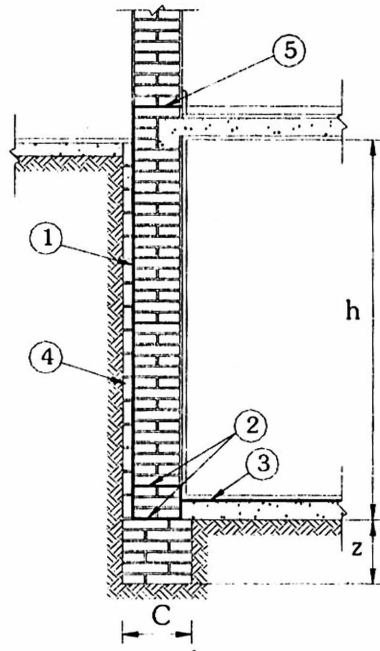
Muro de sótano que muestra la aislación hidráulica (muro contra terraplén).
